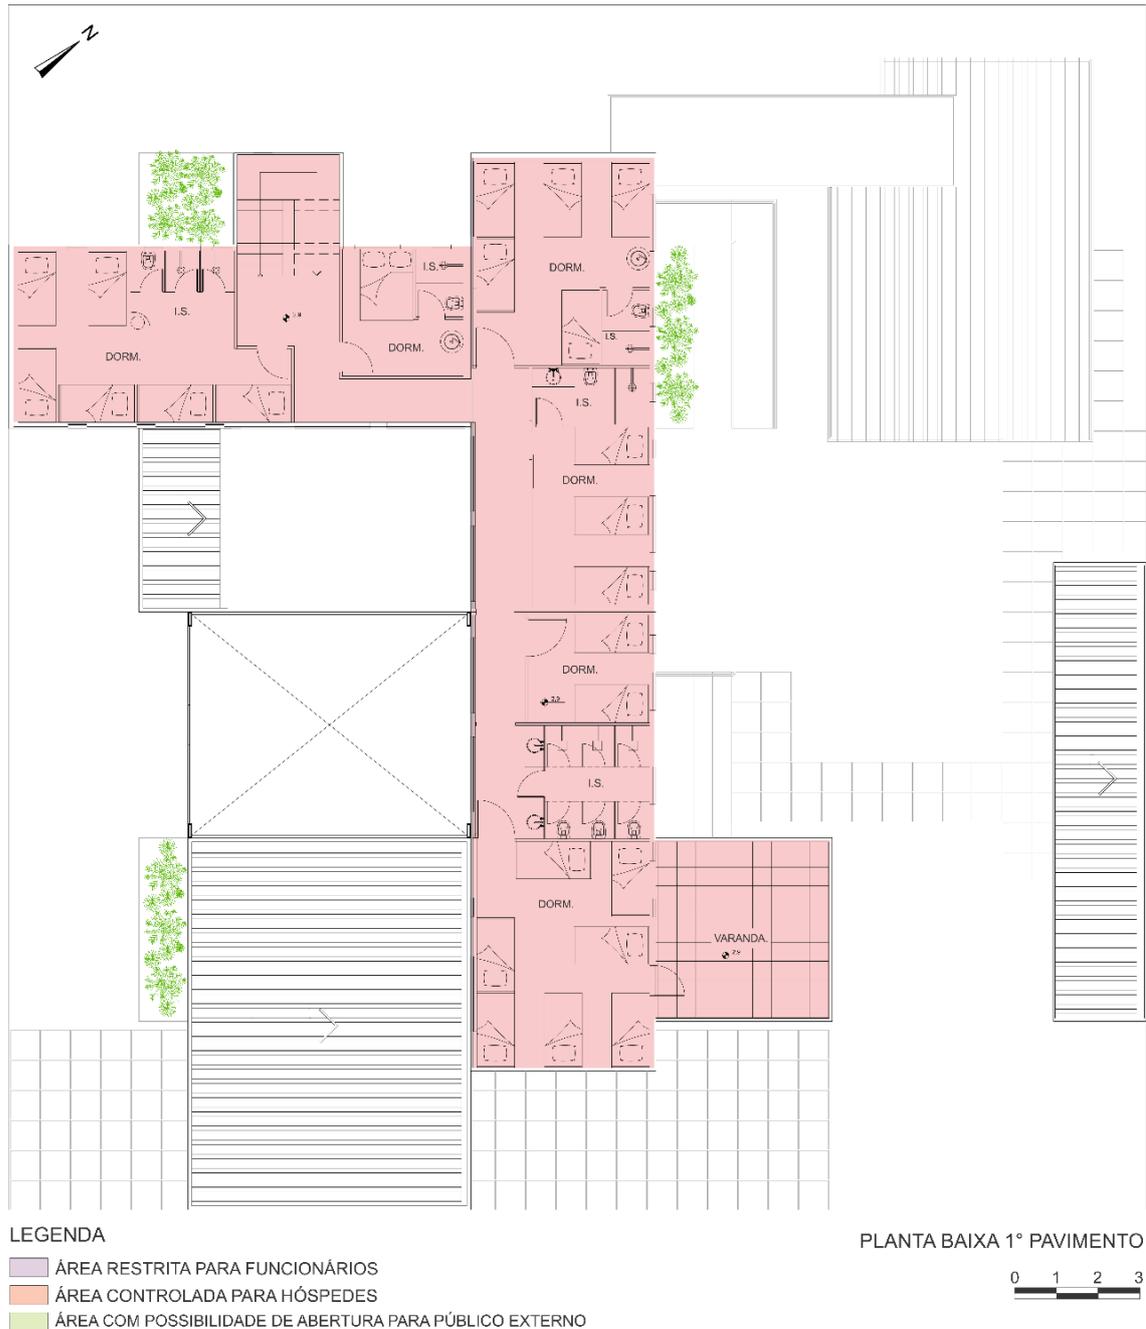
Planta baixa do primeiro pavimento do Tetris Container Hostel. FONTE: KARIN NISIIDE (2016, adaptada pela autora).
